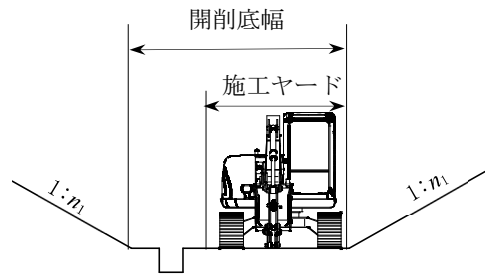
施工ヤードとしての利用を考慮した堤体開削断面の例
